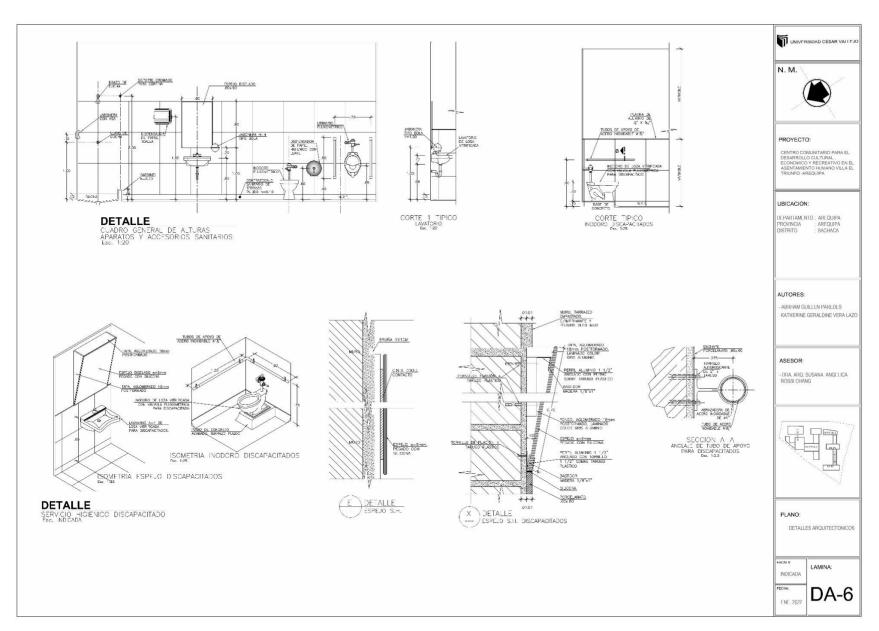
Plano de Detalles Arquitectónicos (Baño de Discapacitados) - Elaboración propia
